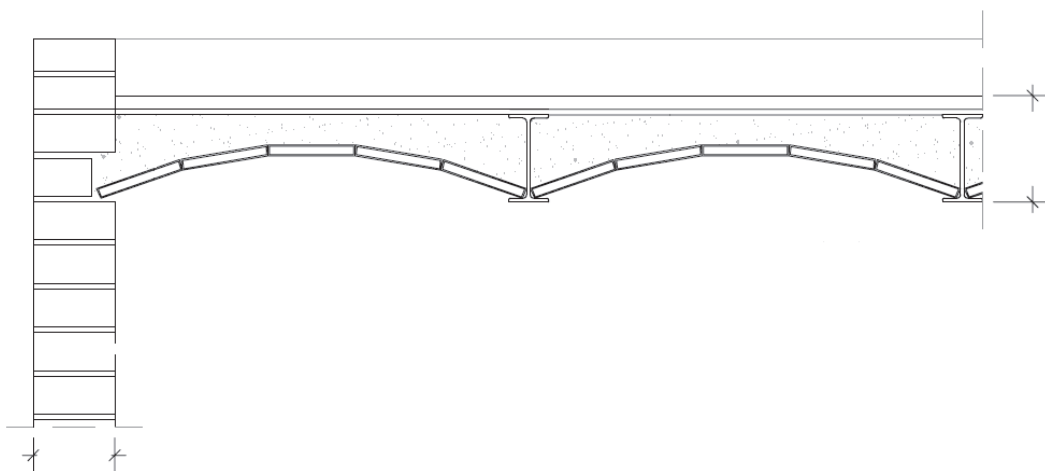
Detalle constructivo de un forjado con vigueta de acero y arco cerámico.
